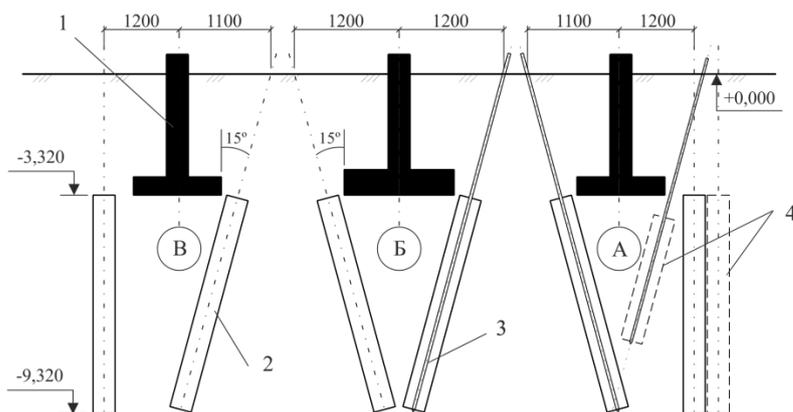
Схема закрепления грунтов основания в поперечном сечении:
